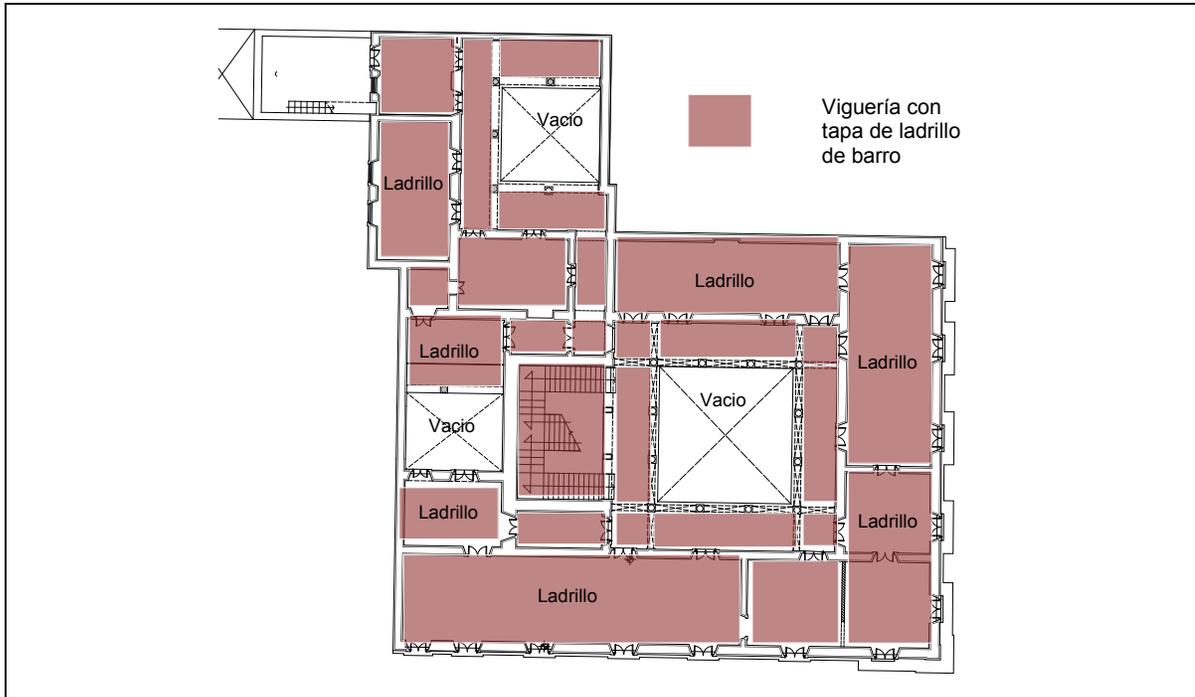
Tapas sobre viguería de madera en cubierta de la casa de Isidro Huarte, estado actual.
